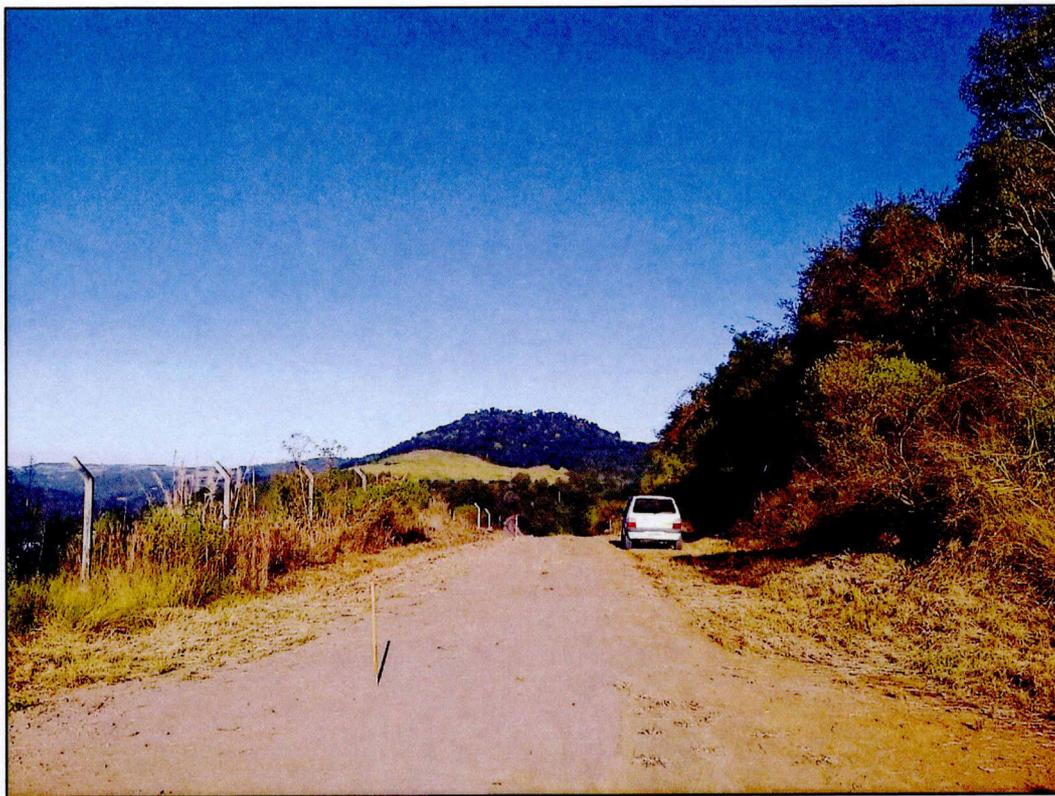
vista central do leito da Rua existente a ser regularizada;
